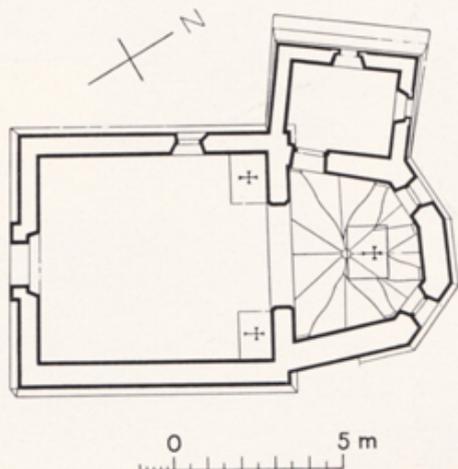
Grundriss. — Maßstab 1:300.
